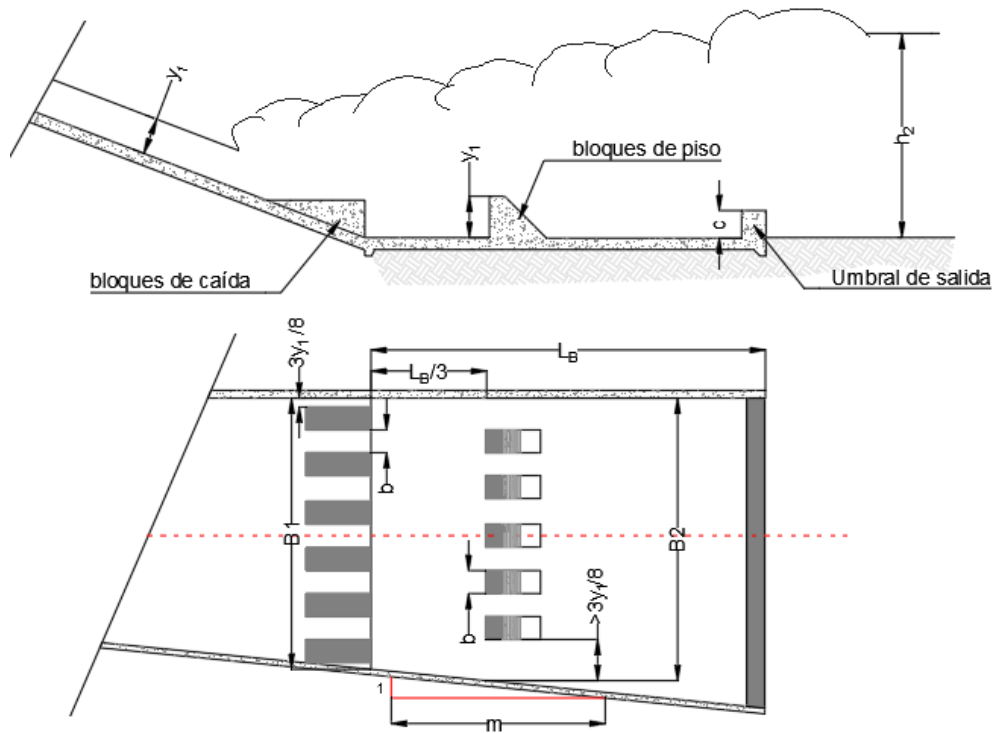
Tanque amortiguador tipo SAF. Vista de planta y longitudinal
